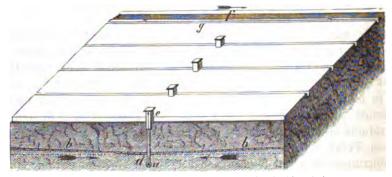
v. Raumer's Schliefapparat jur Beterfen'ichen Drainbewäfferung.
